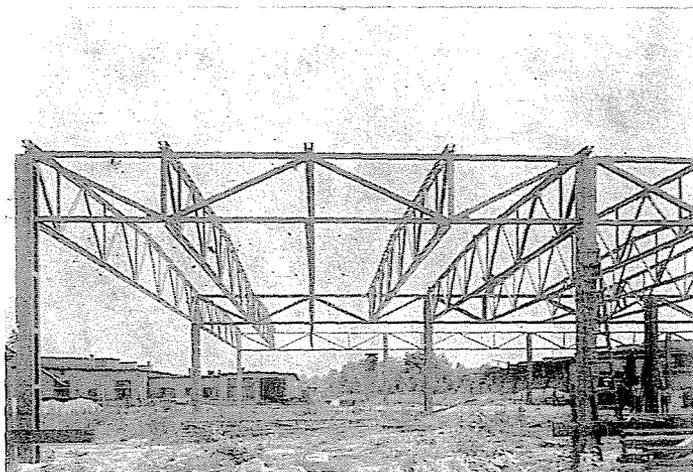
Structure d'une halle industrielle 12 × 18 m
